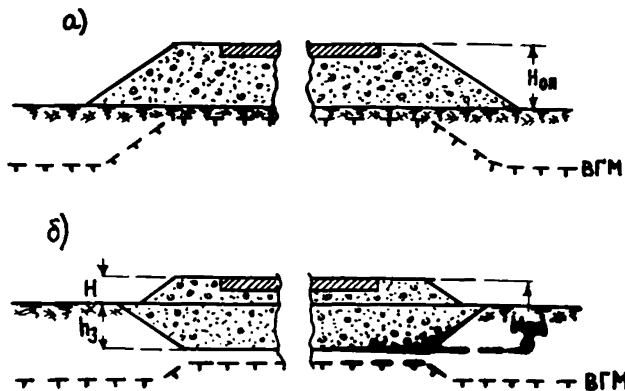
Схема аэродромного сооружения на вечномерзлых грунтах: а - аэродромное сооружение в насыпи; б - Замена грунта в основании аэродромного сооружения
